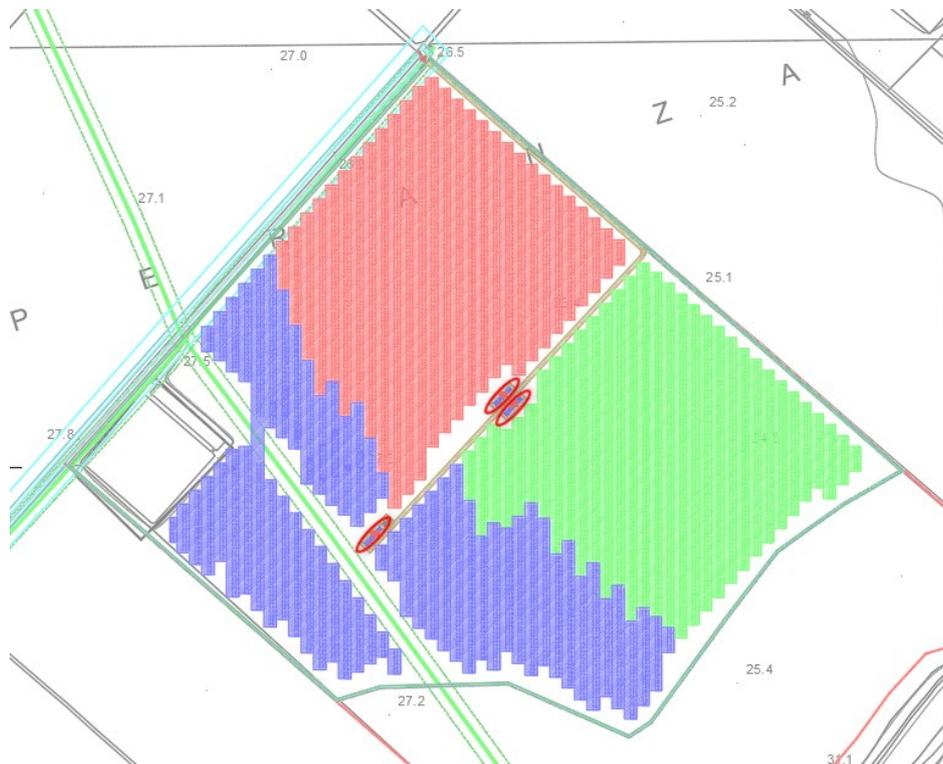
Vista Planimetria dell'impianto FV con l'ubicazione delle C.U. - Area Est
